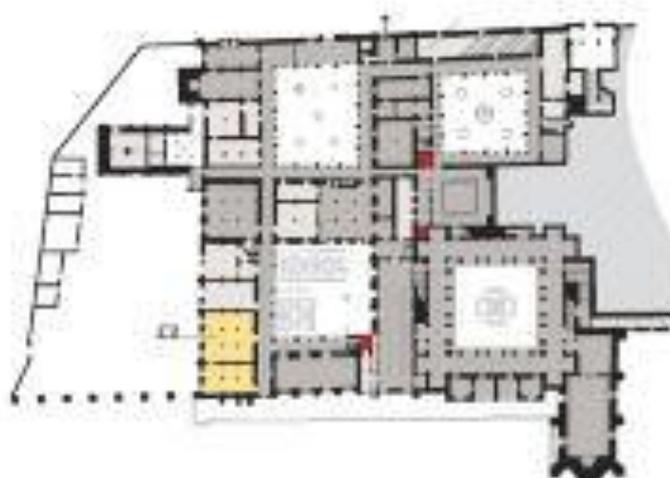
Plano do Terceiro Piso (Pereira, 2009, p.9)
